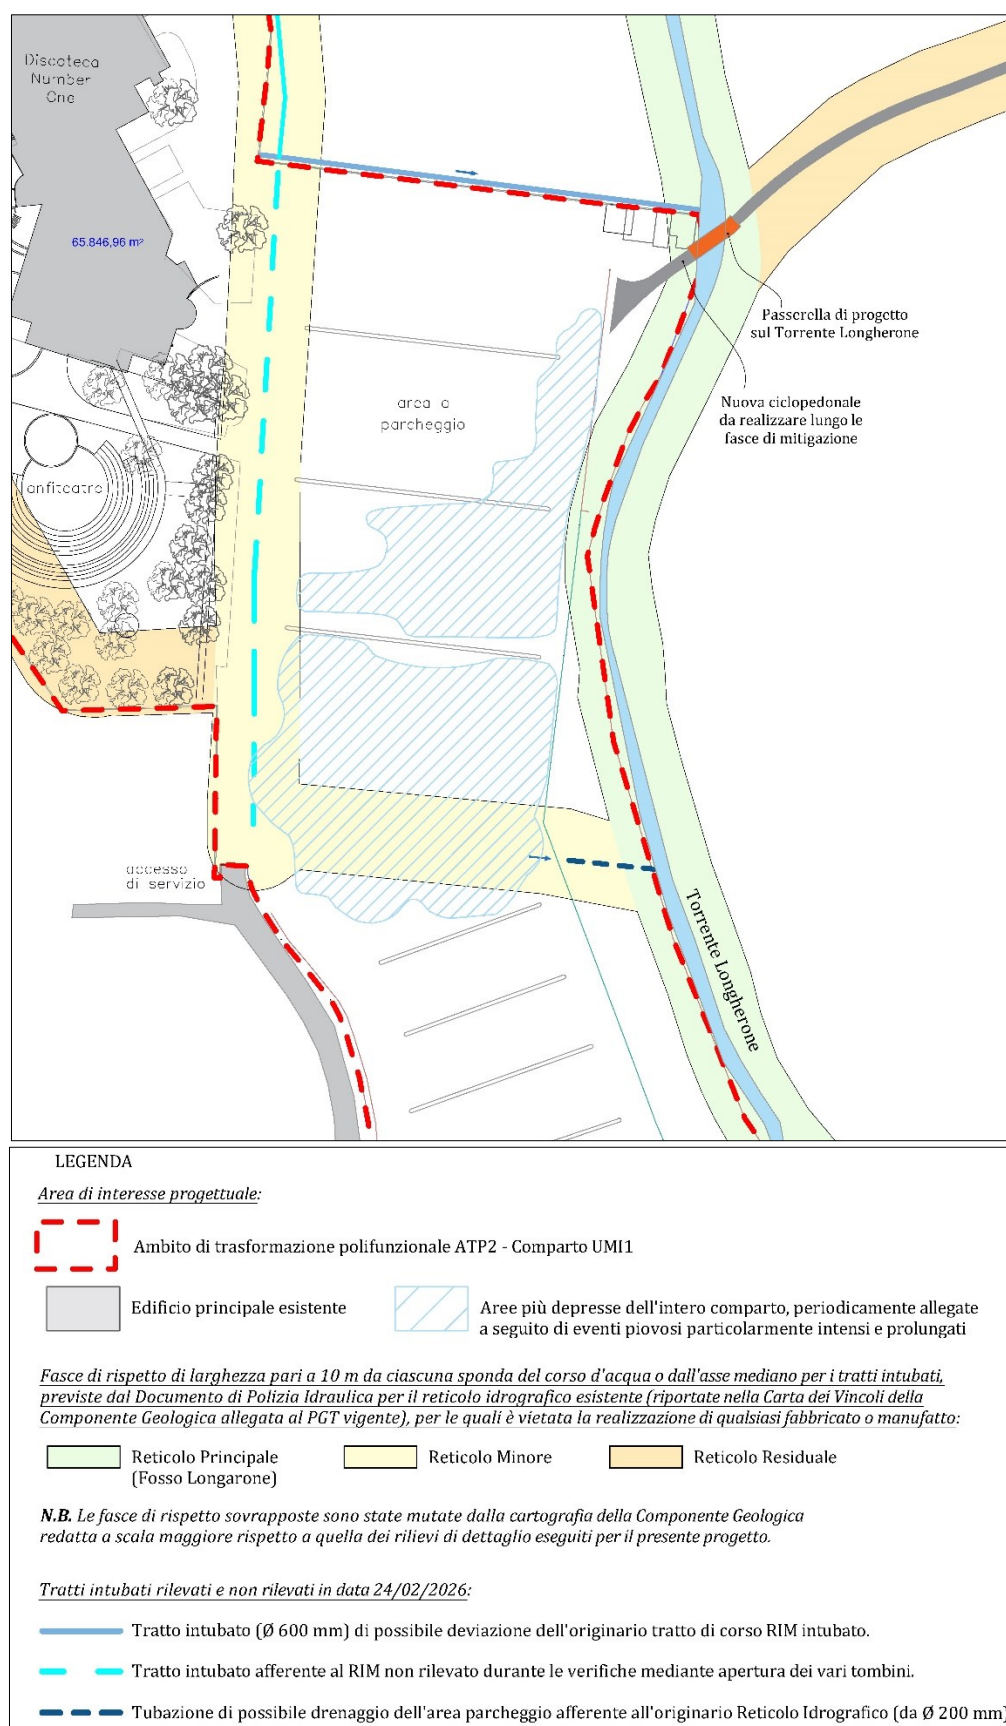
Planimetria dello stato di fatto con sovrapposizione delle fasce di rispetto vigenti ed indicazione degli elementi idrografici rilevati, con ubicazione della passerella di attraversamento del Torrente Longherone.
